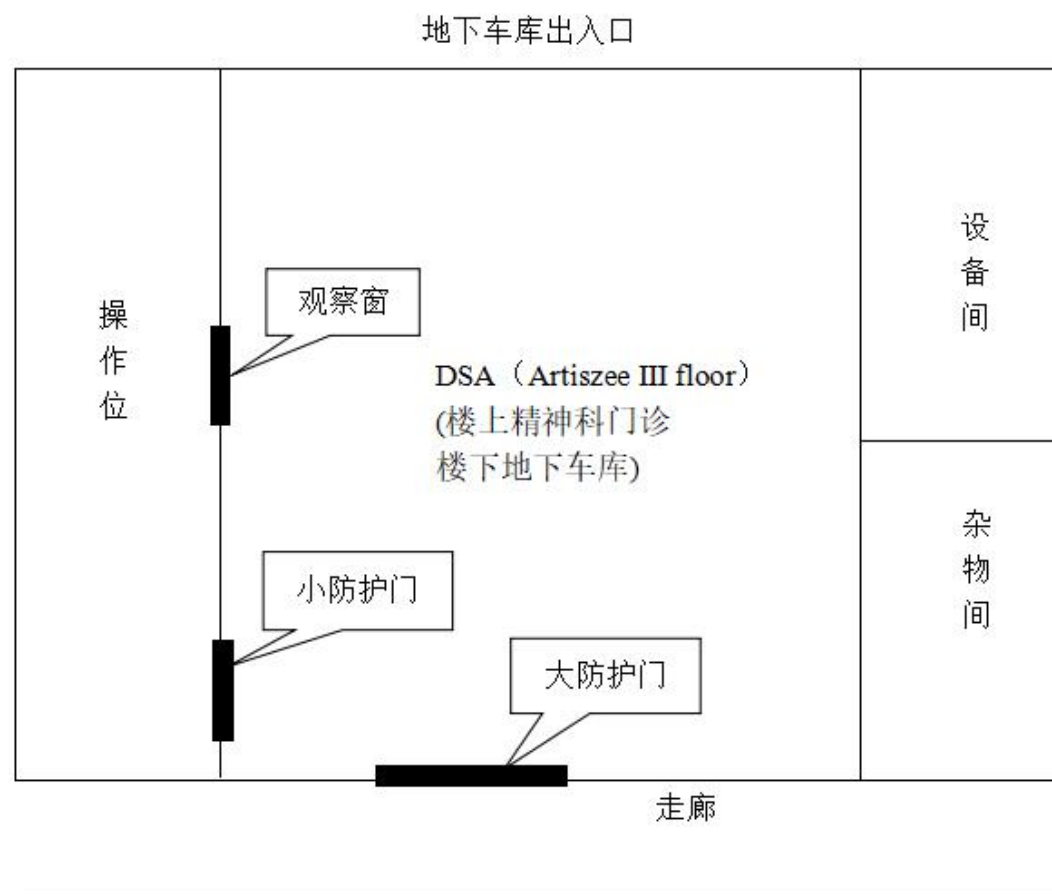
菏泽市第三人民医院 DSA 室平面布置示意图
